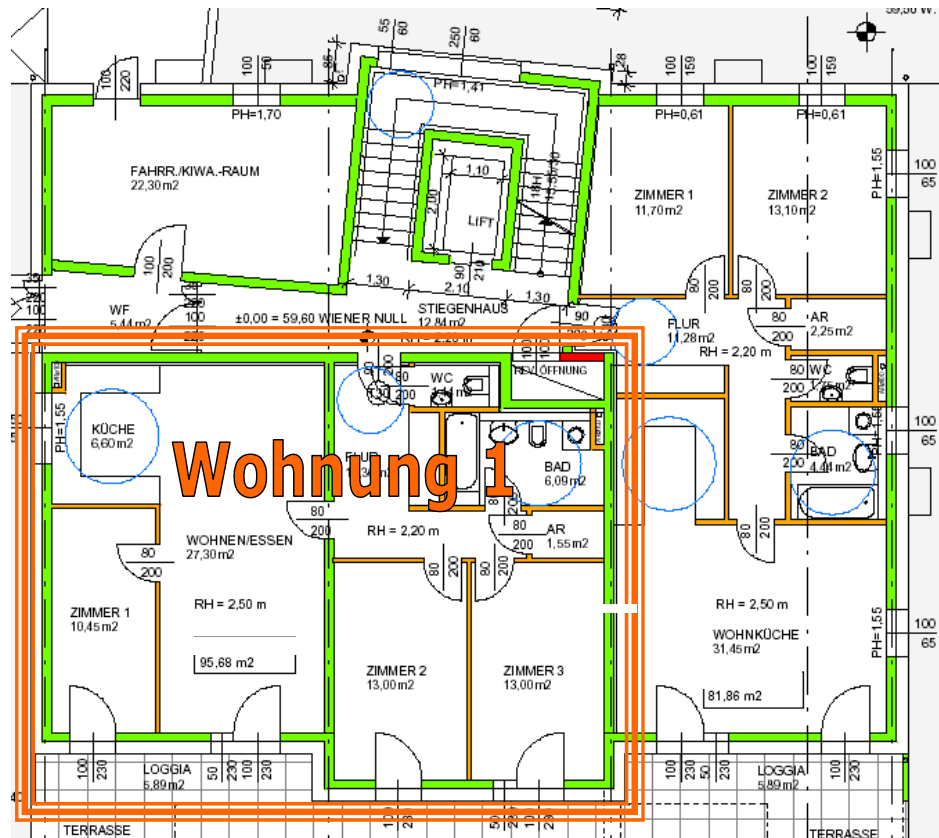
Grundriss Erdgeschoss Haus 2 mit der Lage der 1. Messwohnung [Arch. DI Franz Kuzmich]
